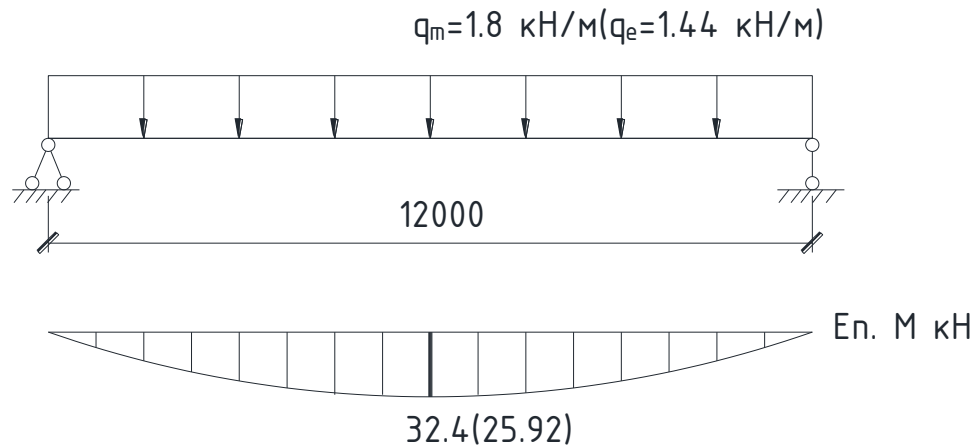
Розрахункова схема балки, епора згинальних моментів.
